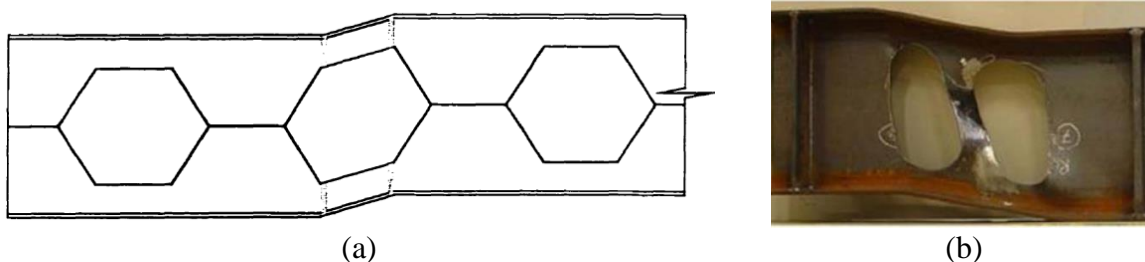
Formação do Mecanismo Vierendeel em (a) viga castelada (DEMIRDJIAN, 1999); (b) viga com furo alongado (TSAVDARIDIS; D'MELLO, 2011)
